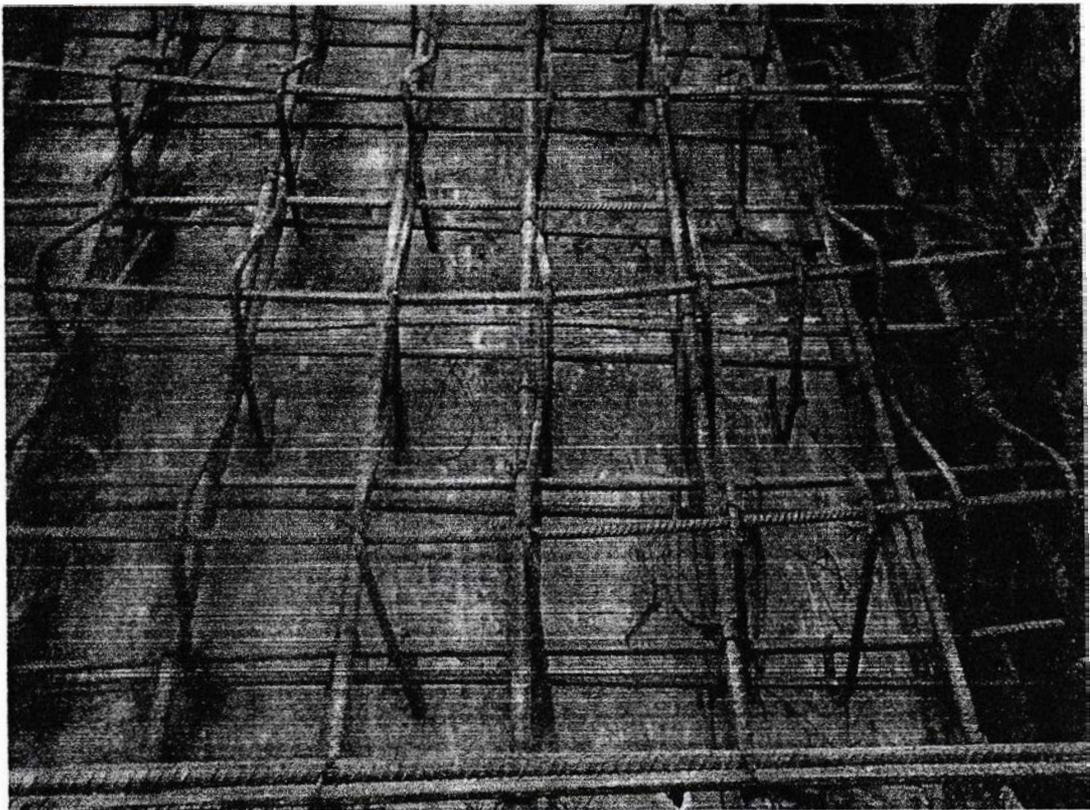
Pemasangan Bekisting Balok dan Plat Tangga
